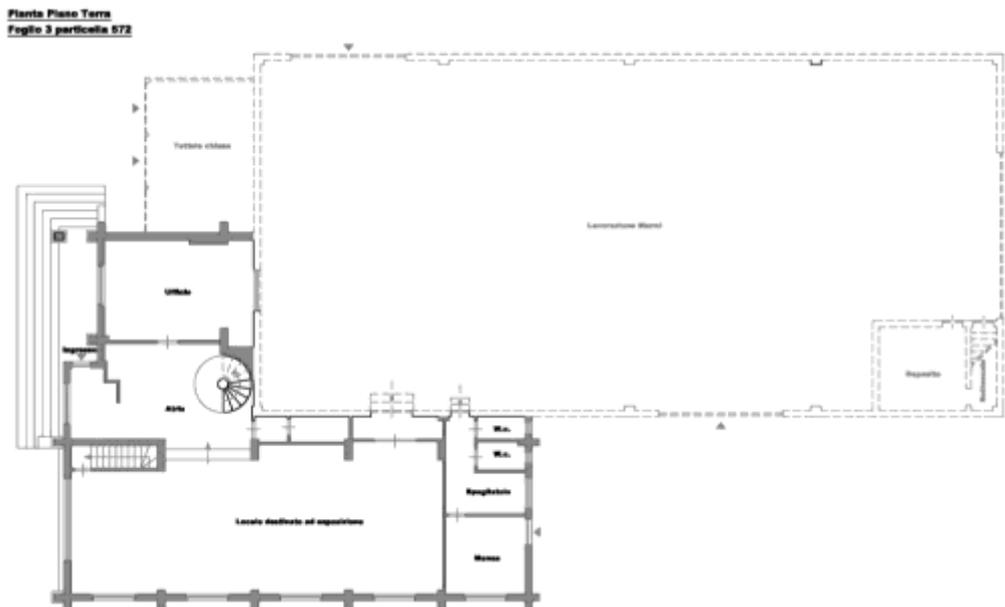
Pianta Piano Terra_Corpo 2 "Fabbricato"
